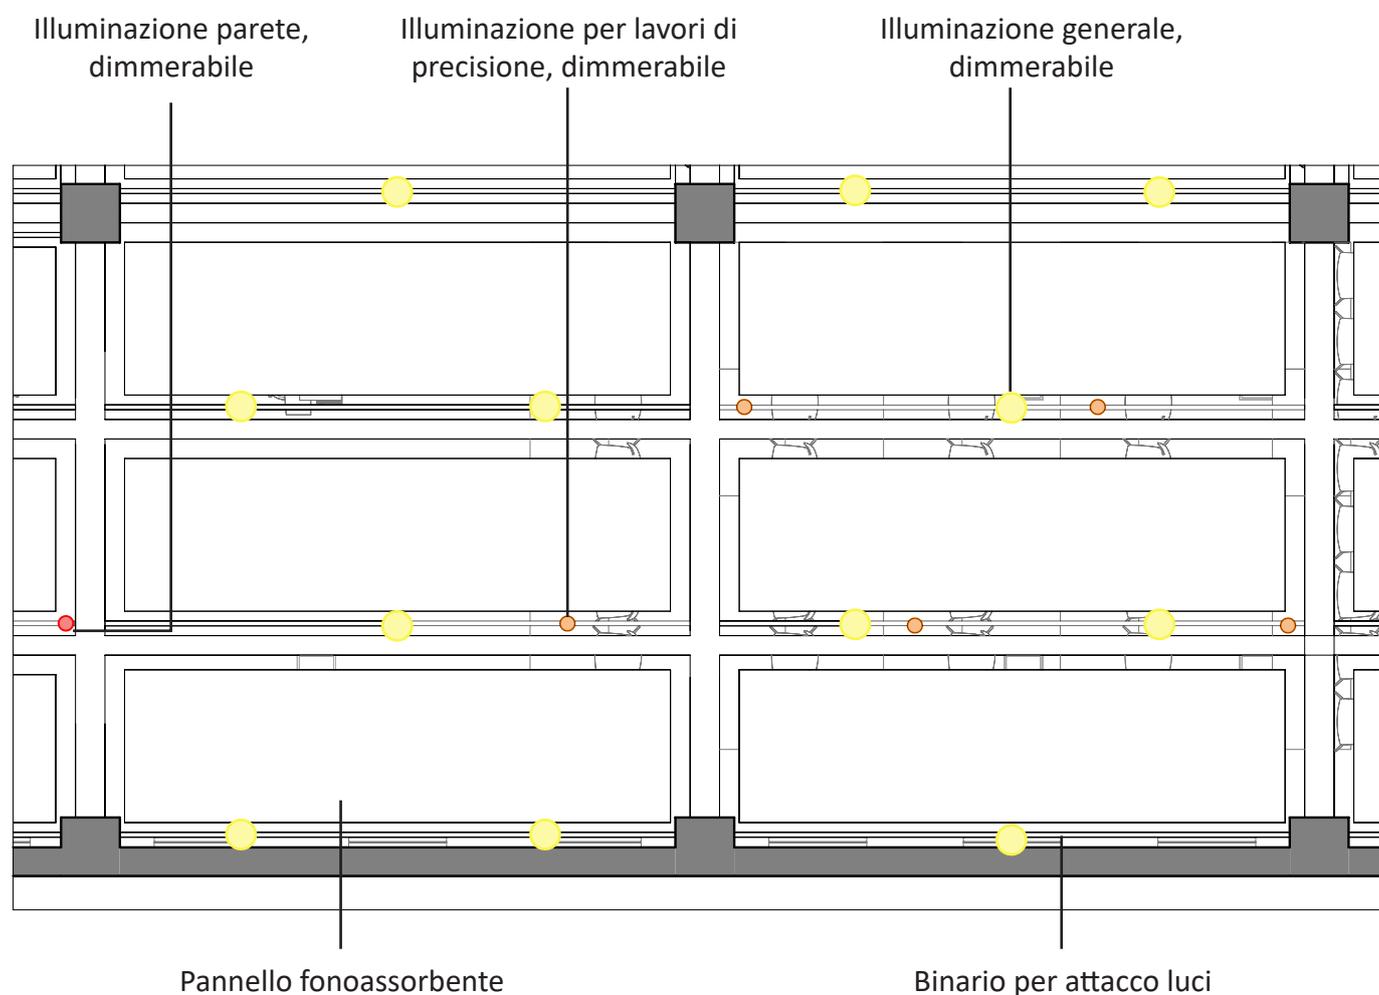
ESTRATTO SDP PIANTA DEL CONTROSOFFITTO
